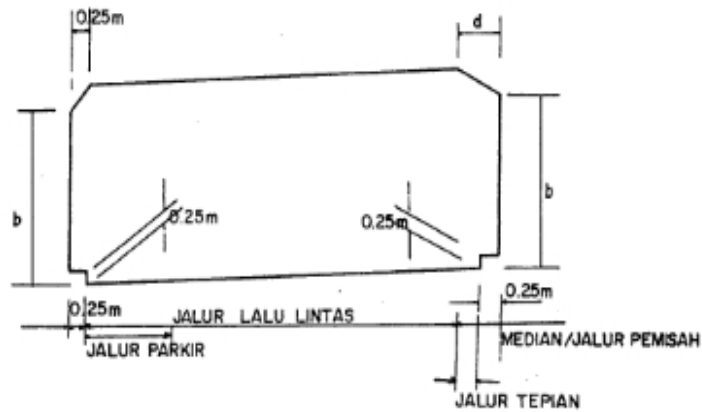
Ruang bebas untuk jalur lajur lintas dengan bahu jalan
